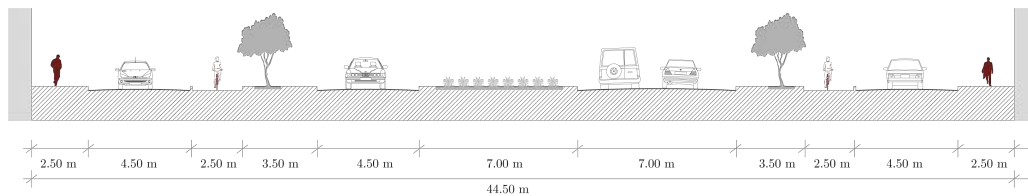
Sección de la calle Gaston Fabrèlaan y Krijgsbaan. Elaboración: Propia
